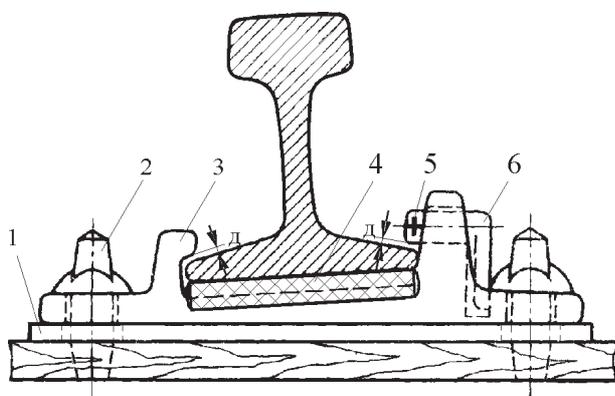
Промежуточное скрепление типа «Метро»:
